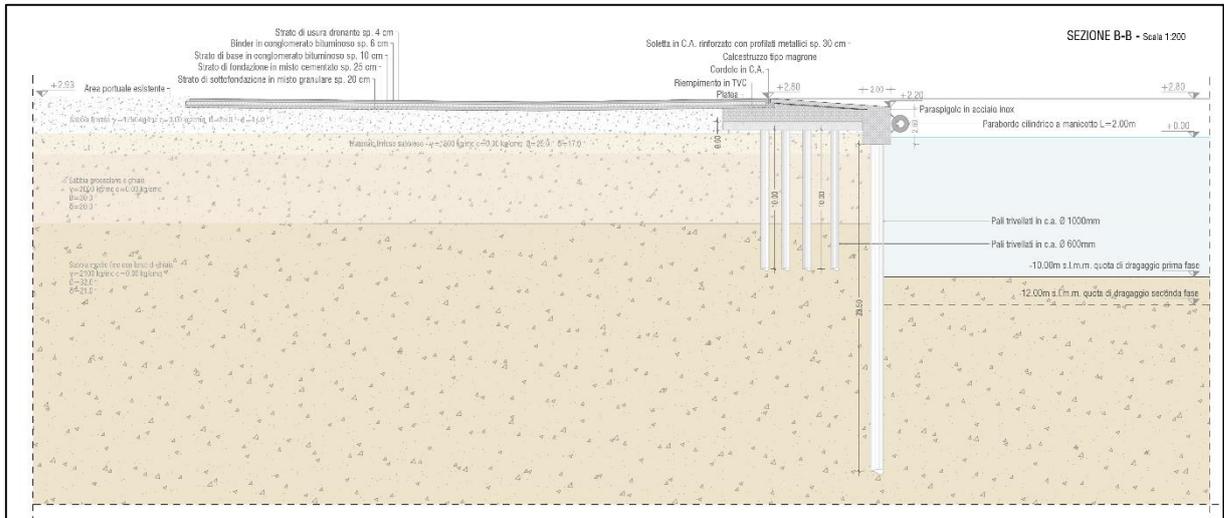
Banchina di progetto -Sezione Tipo B-B (Elab. EG.09)
